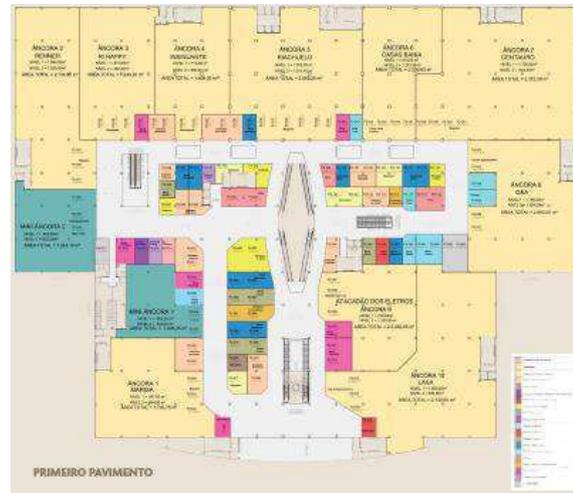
PLANTA BAIXA PRIMEIRO PAVIMENTO (P2)
